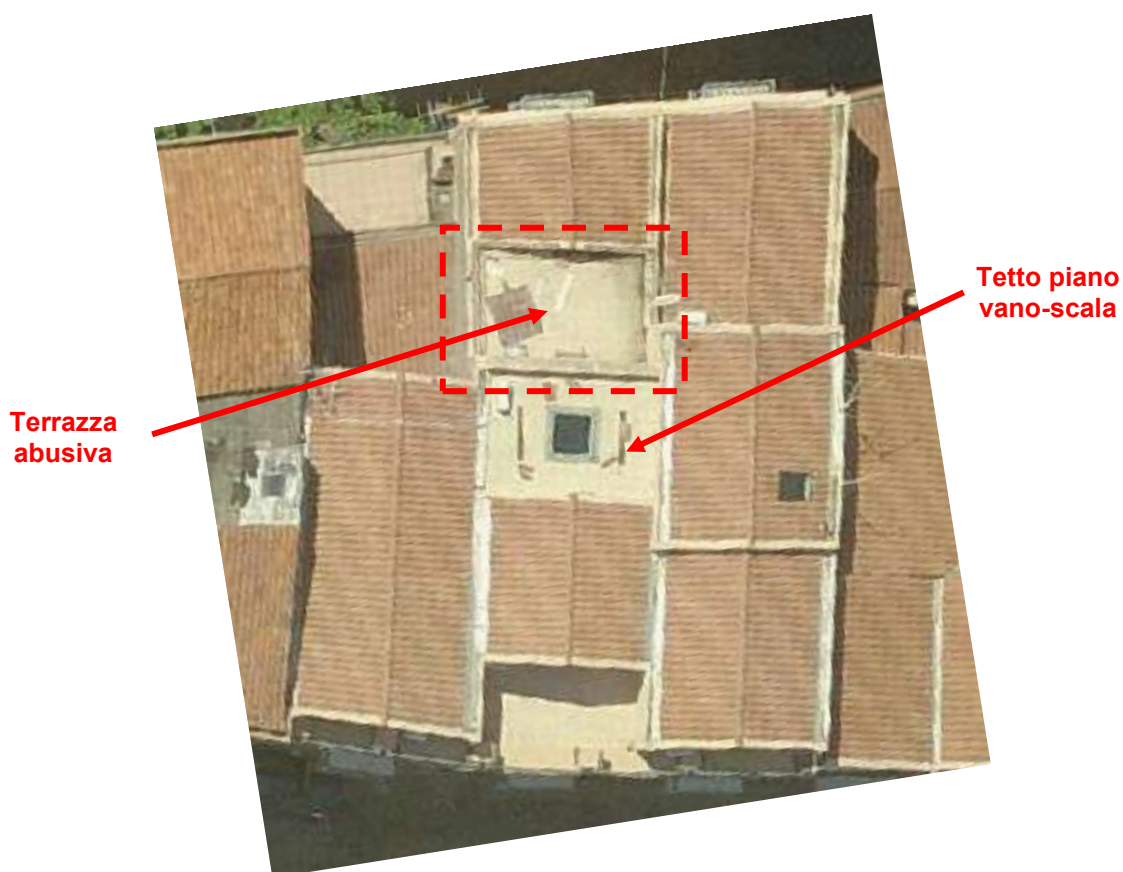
Zoom ortofoto su coperture con opportuna rotazione. Nord in basso
